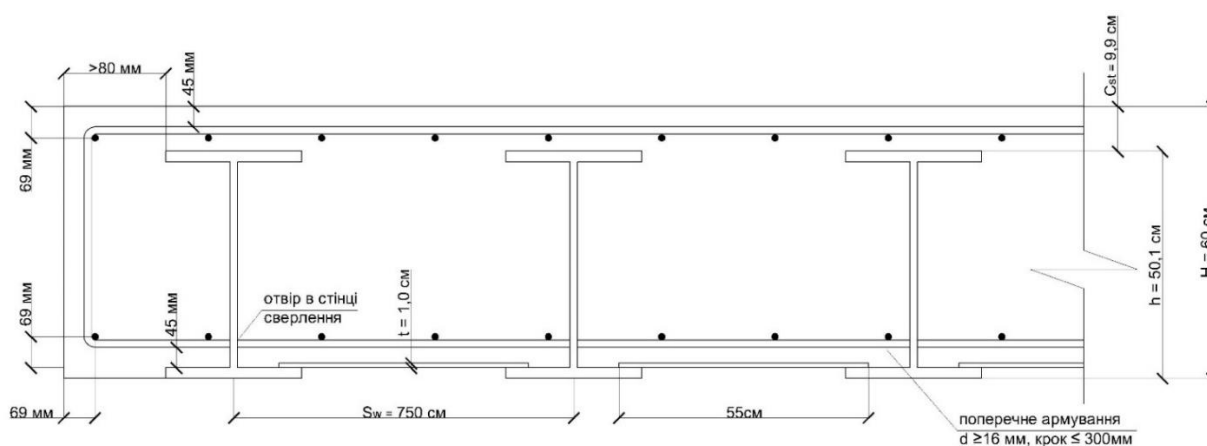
Фрагмент плити прогонової будови у поперек мосту
